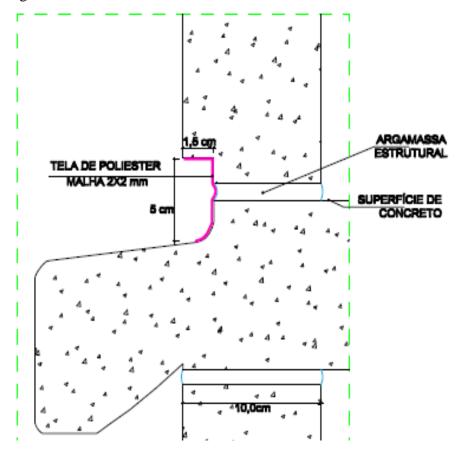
Detalhe do rebaixo para ligação entre painéis.
